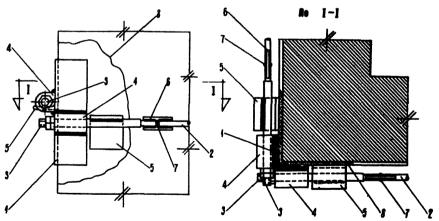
Схема углового обжимного элемента с одиночными тяжами:
